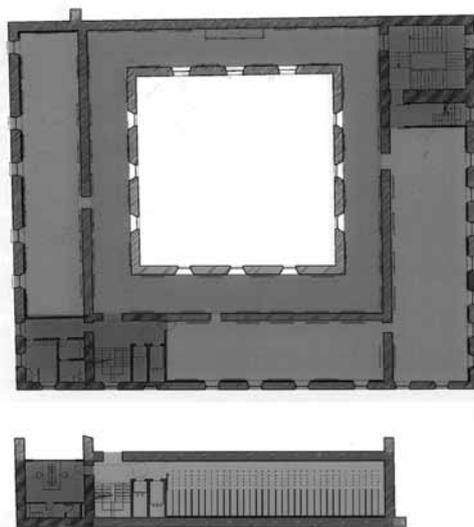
Plano de la planta baja y sótano del Convento. Plano: Manuel Cuadrado Isasa.
